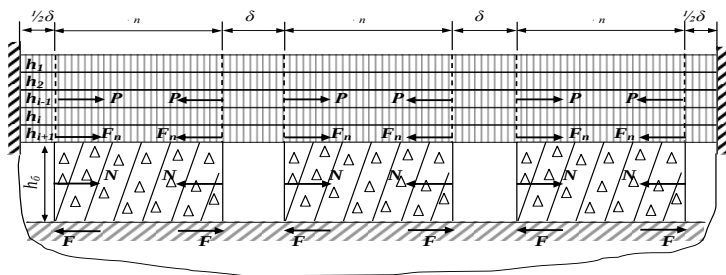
Розрахункові схеми роботи асфальтобетонних шарів на цементобетонній основі:
